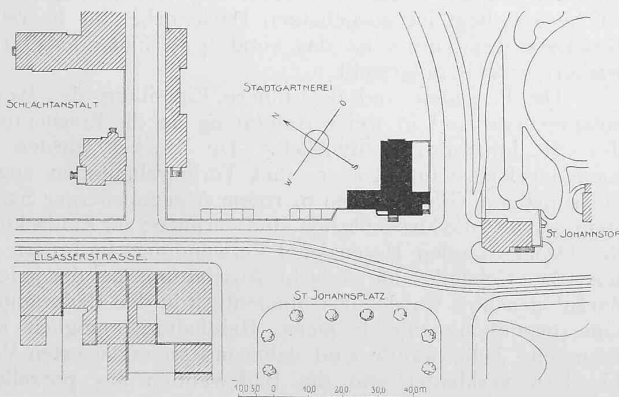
Lageplan der Brausebadanlage St. Johann in Basel. Masstab 1 : 2000.
